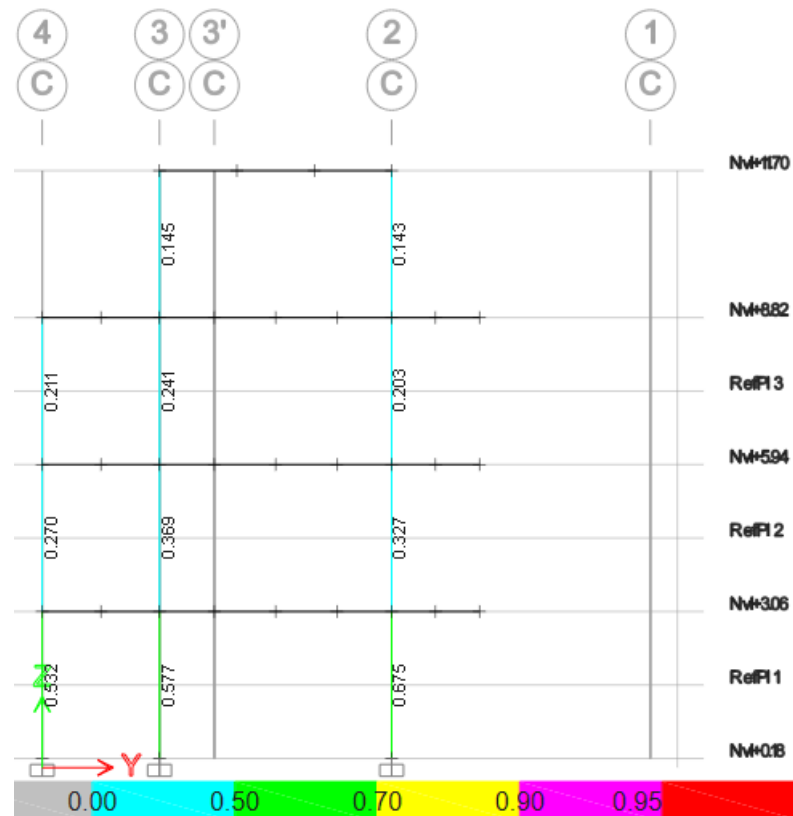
Diseño de columnas rellenas de hormigón del eje C
